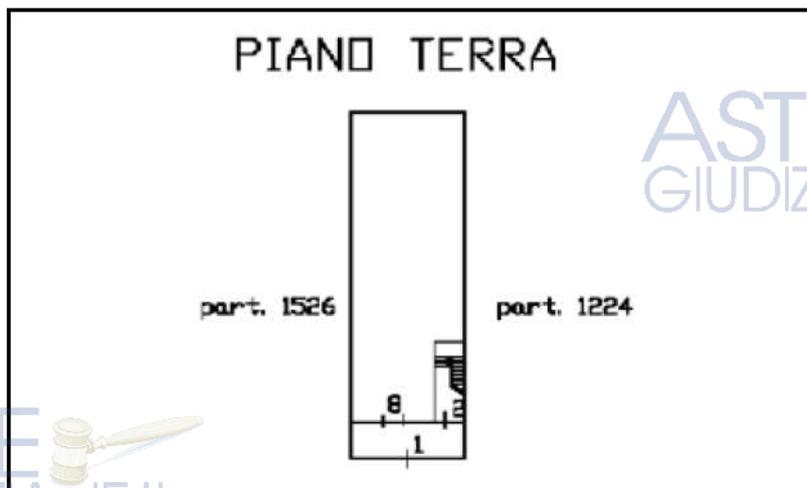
Elaborato planimetrico catastale del piano terra del fabbricato identificato con la part.1525.
